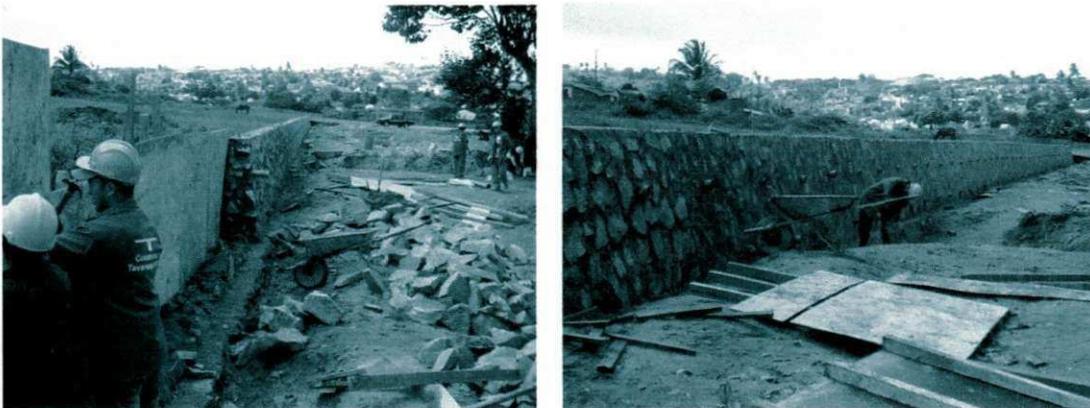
e 6 – Fonte Direta: Muros de Arrimo
